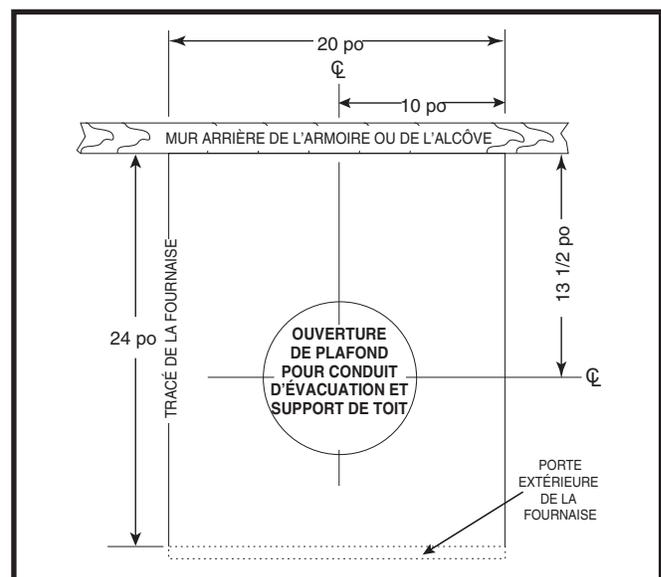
Dimensions de coupe pour le conduit d'évacuation et le support de toit
